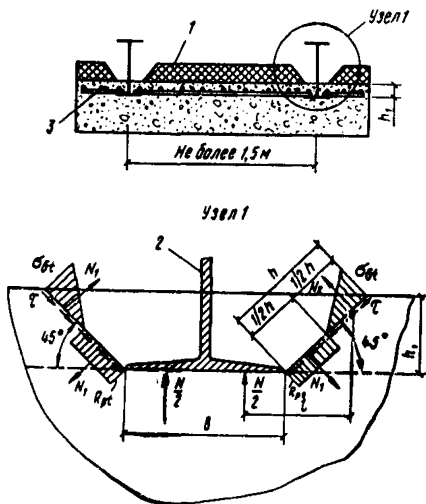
Расчетная схема определения прочности заделки металлической балки в бетон плиты.
